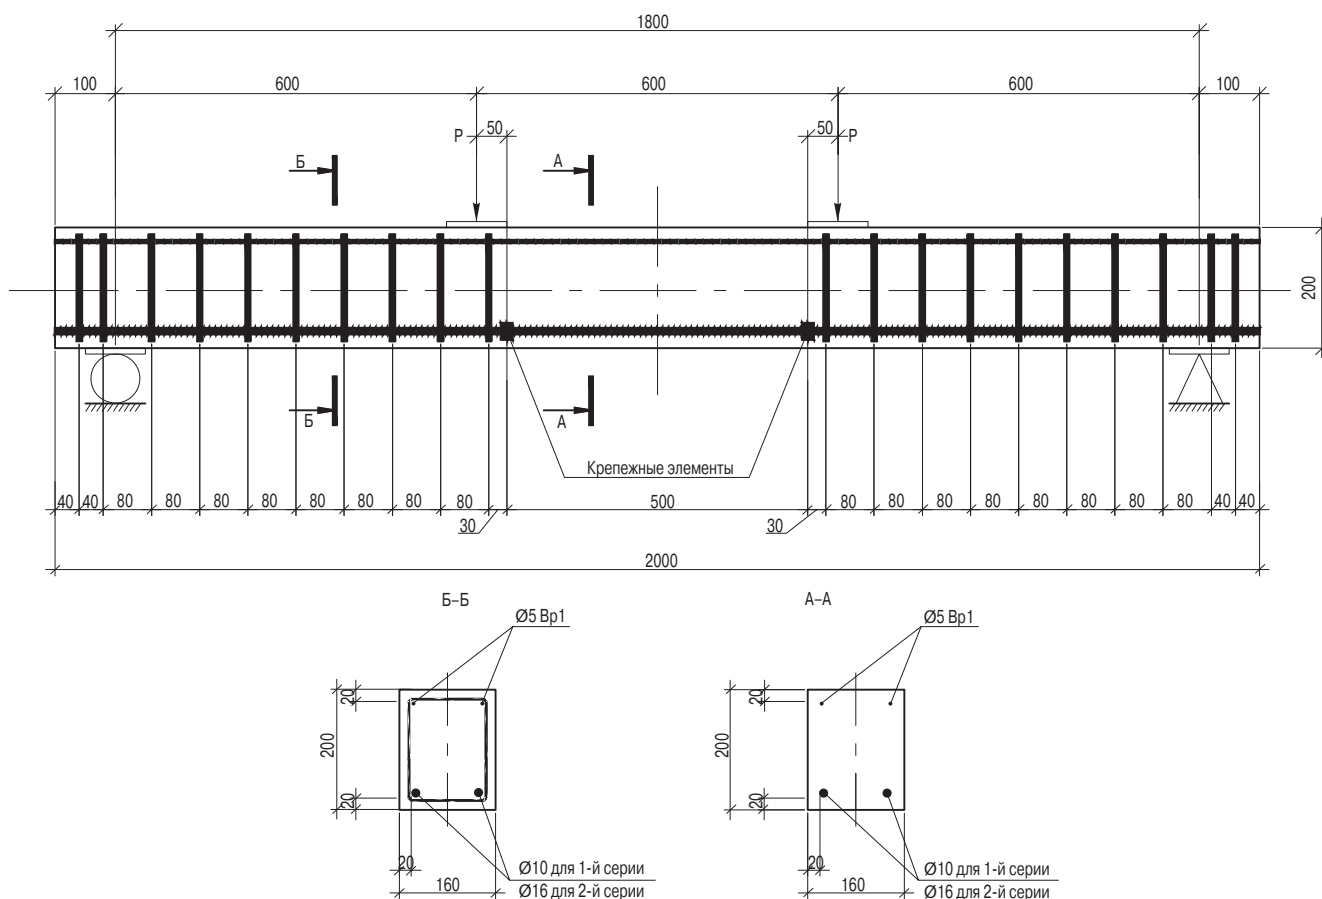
Схема армирования 1-й и 2-й серий опытных балок
